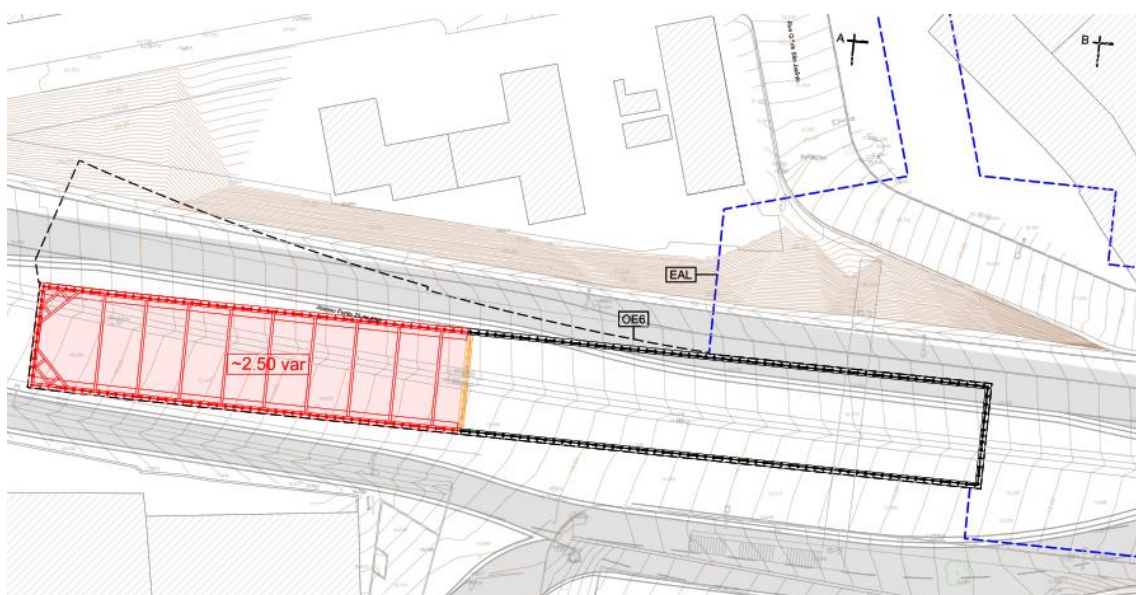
Planta de Dimensionamento Contenção Provisória – 2ª Fase de escavação
